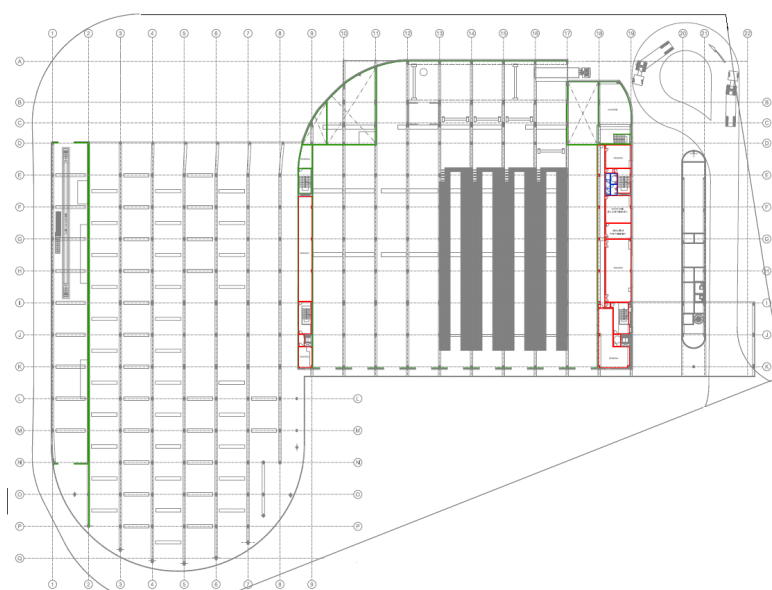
Plano Planta Baja Talleres y Cocheras. Fuente: Metrotenerife (MTSA)
